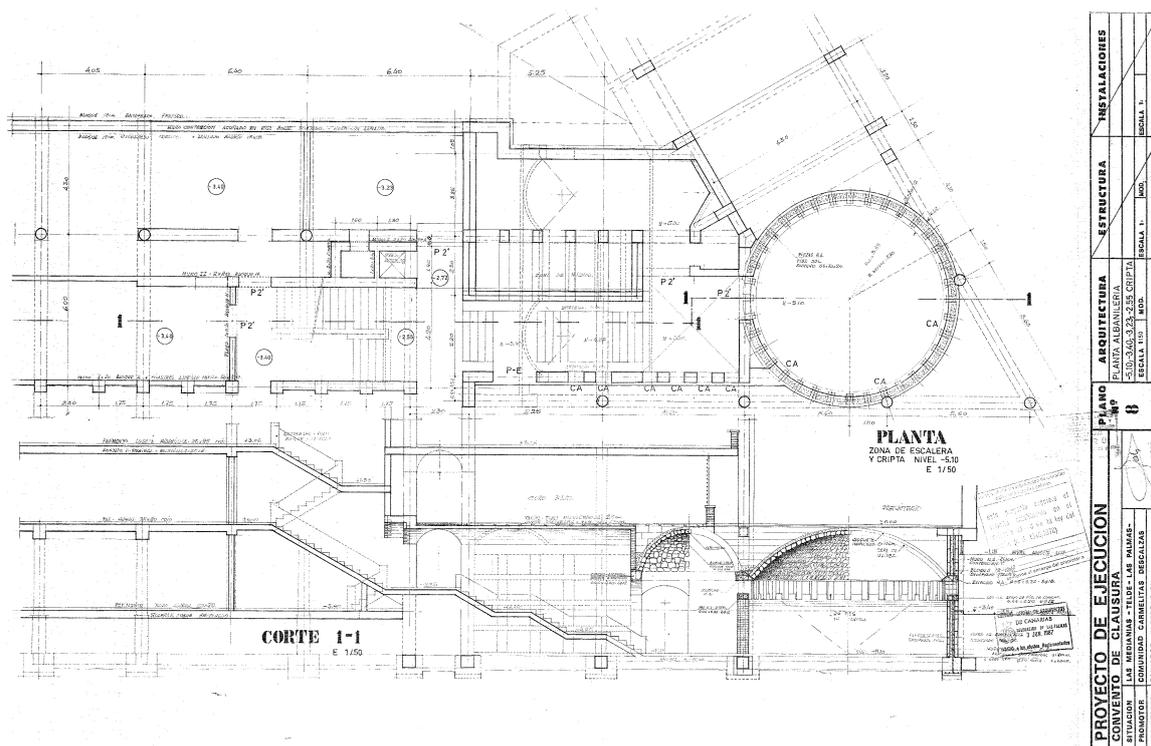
Convento Carmelita de Telde. Plano de planta sótano.
